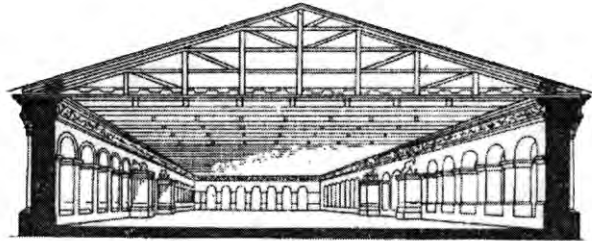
Поперечный разрез здания Манежа в Москве, 1817 г. (инженер А. Бетанкур)
